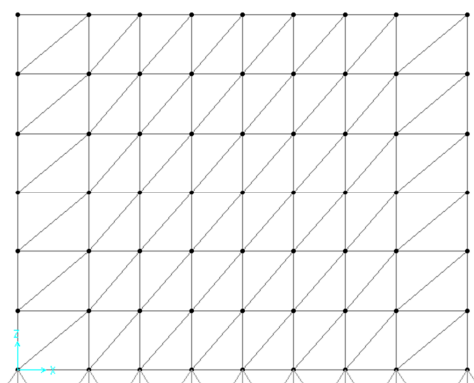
Contraventamento de Plano Vertical em que os Elementos de Contraventamento Funcionam Apenas À Tração
